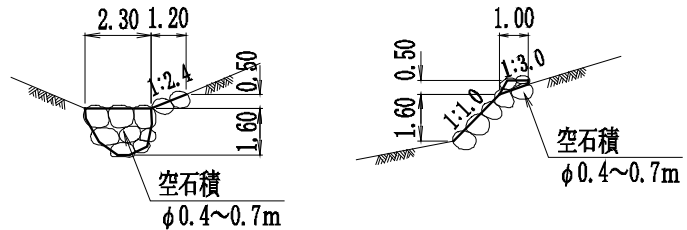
旧金山三ノ谷 谷止工 正面図 (左)・側面図 (右)
